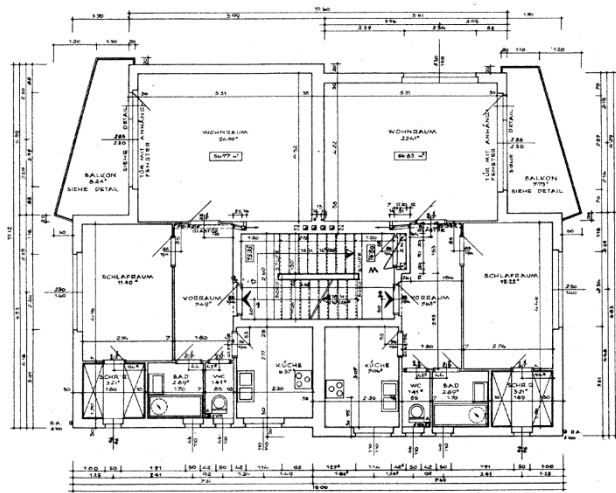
Grundriss. Quelle: Sozialbau AG.
